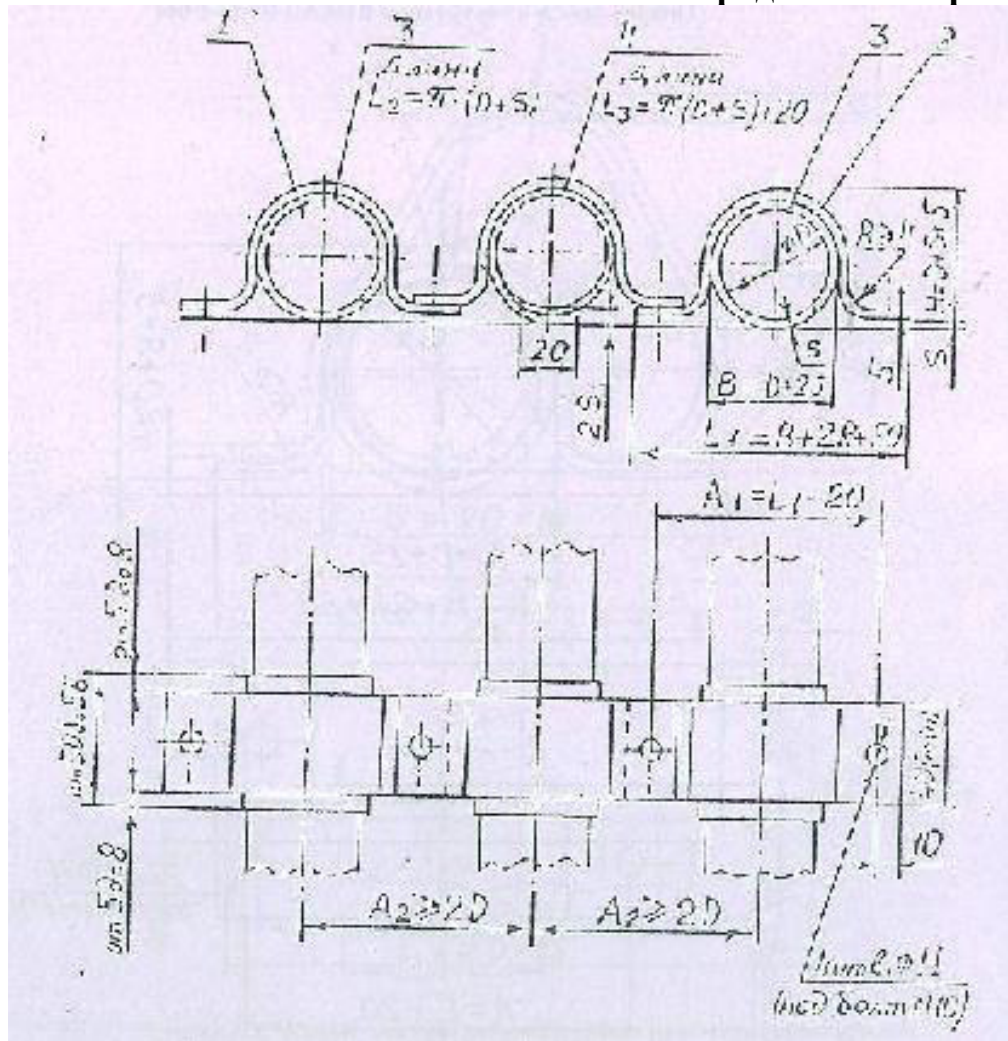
Крепление трёх кабелей на металлоконструкции
